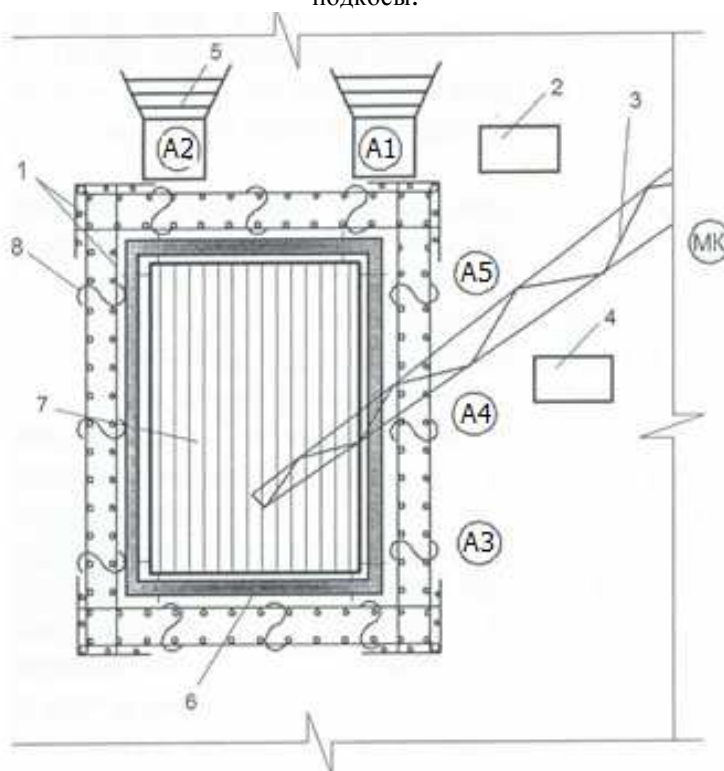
Схема организации рабочих мест при выполнении работ по армированию конструкции монолитного лифтового блока
